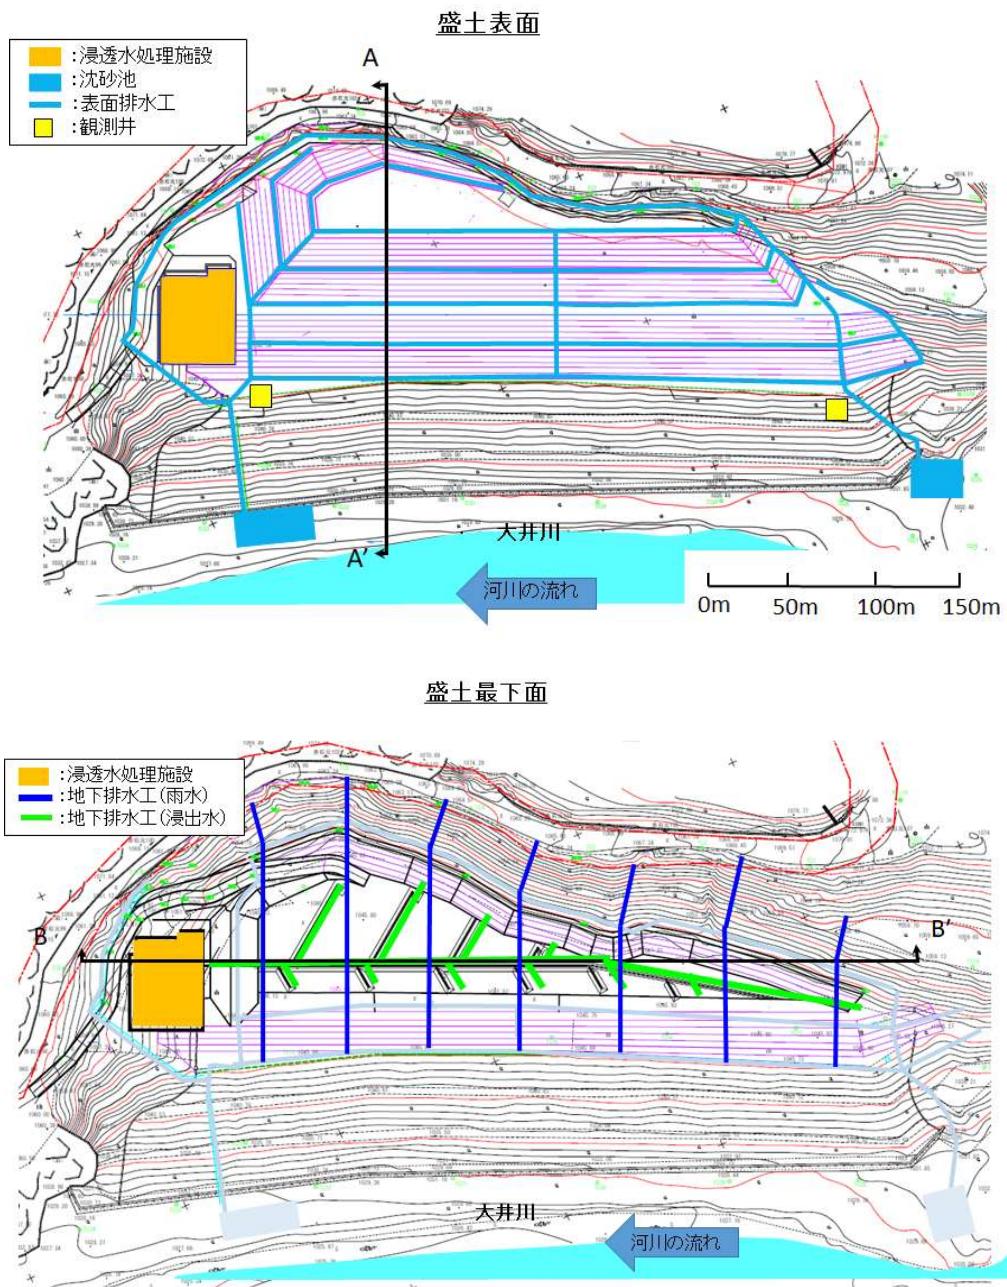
藤島発生土置き場（対策土）の排水設備計画平面図
